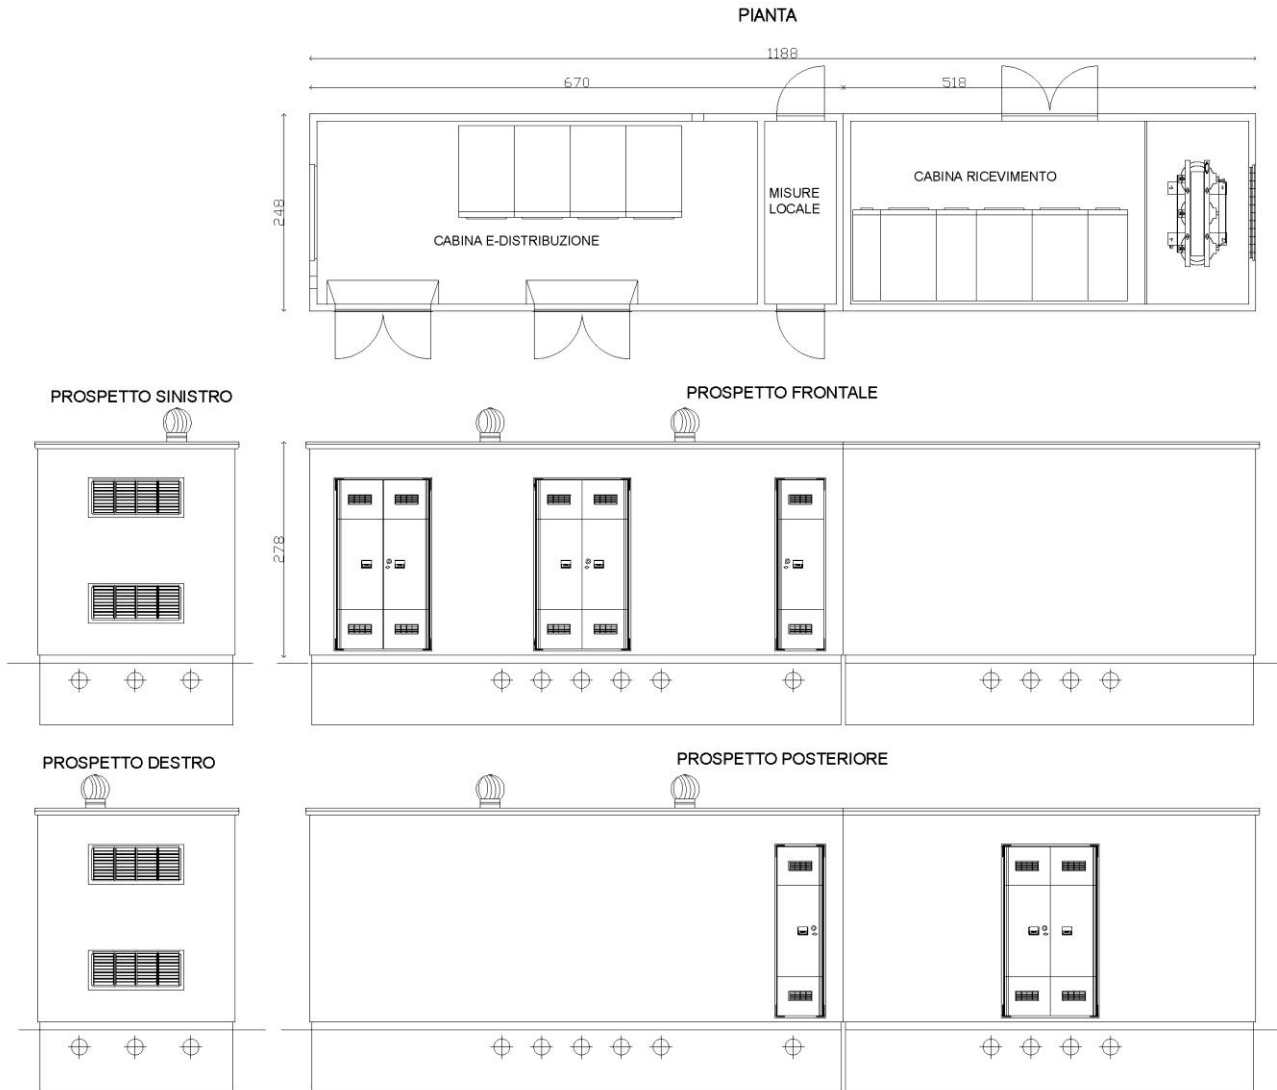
Pianta e prospetti tipo della cabina di ricezione Enel
